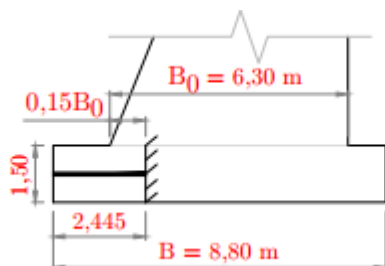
Modelo de cálculo das armaduras da face superior da sapata na direção X
